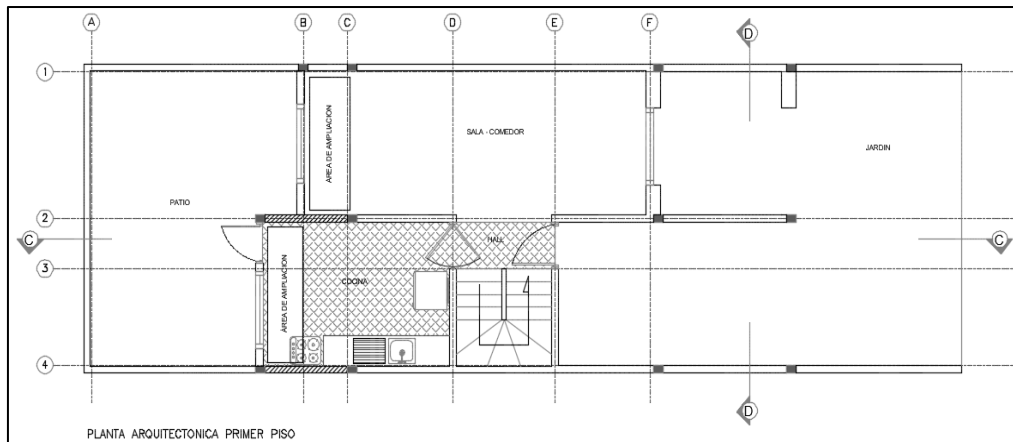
Planta de primer piso. Plano del propietario. Fuente propia
